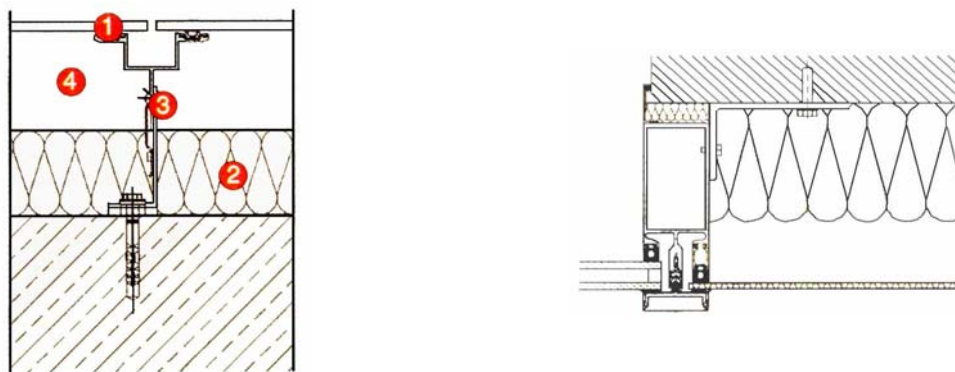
Устройство вентилируемых фасадов фирмой «Техноком»
